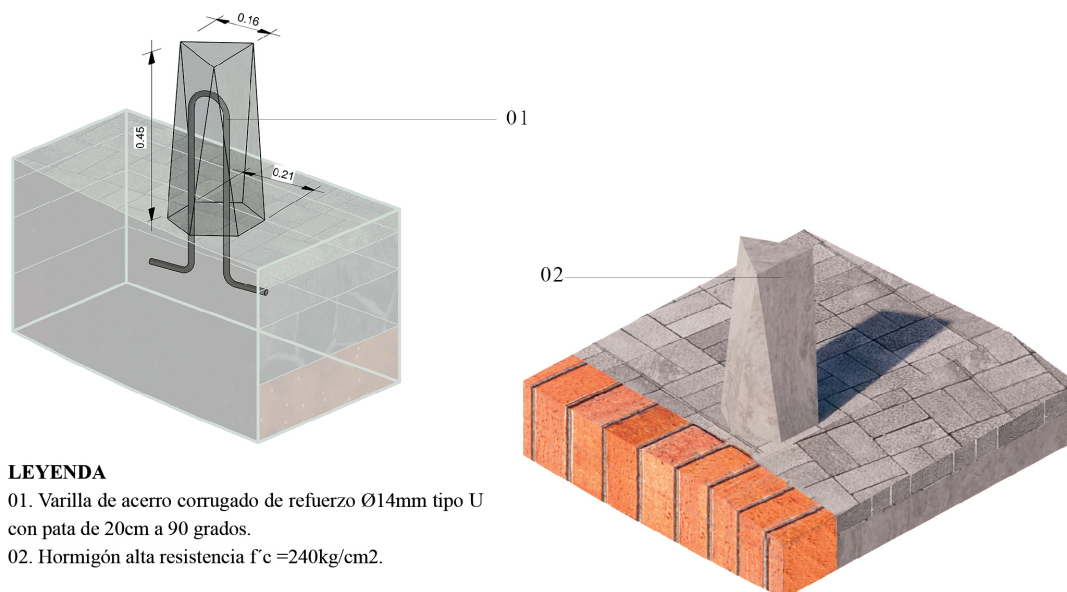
Análisis del sistema constructivo de basurero. Fuente y elaboración: Autoras.
